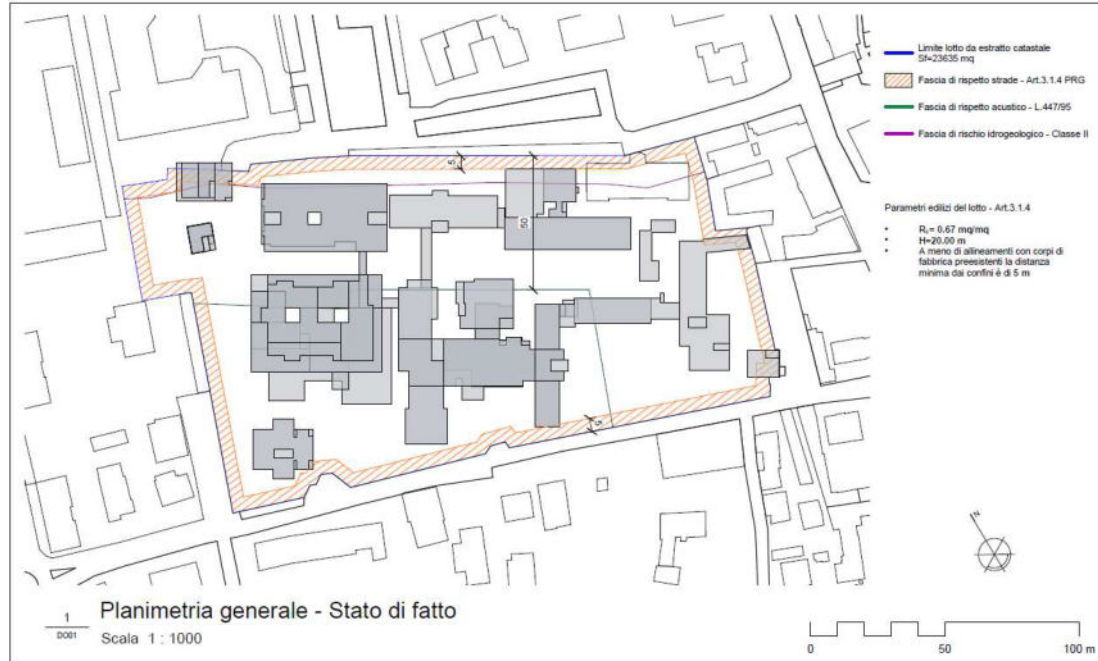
| Fasce di Rispetto con individuazione dell'area oggetto di intervento.
